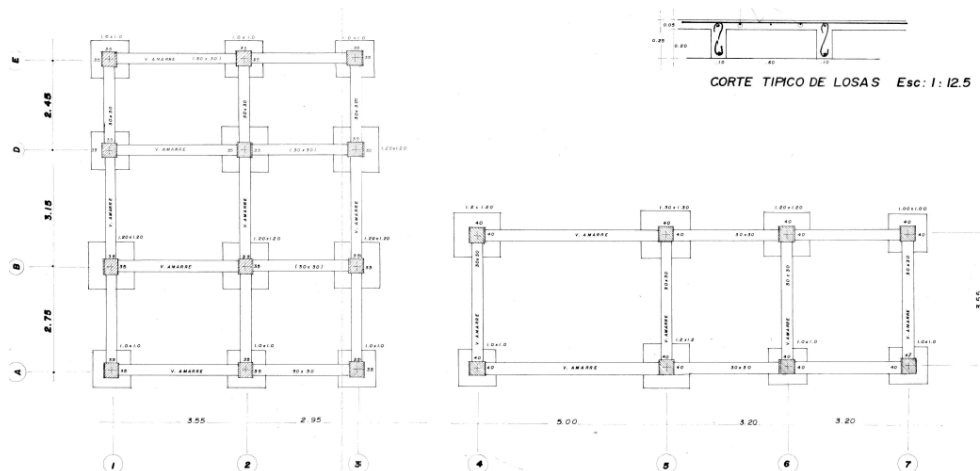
Planta Cimentación. Edificio Plaza Libertador Artes y Oficios. CAJAMAG.
